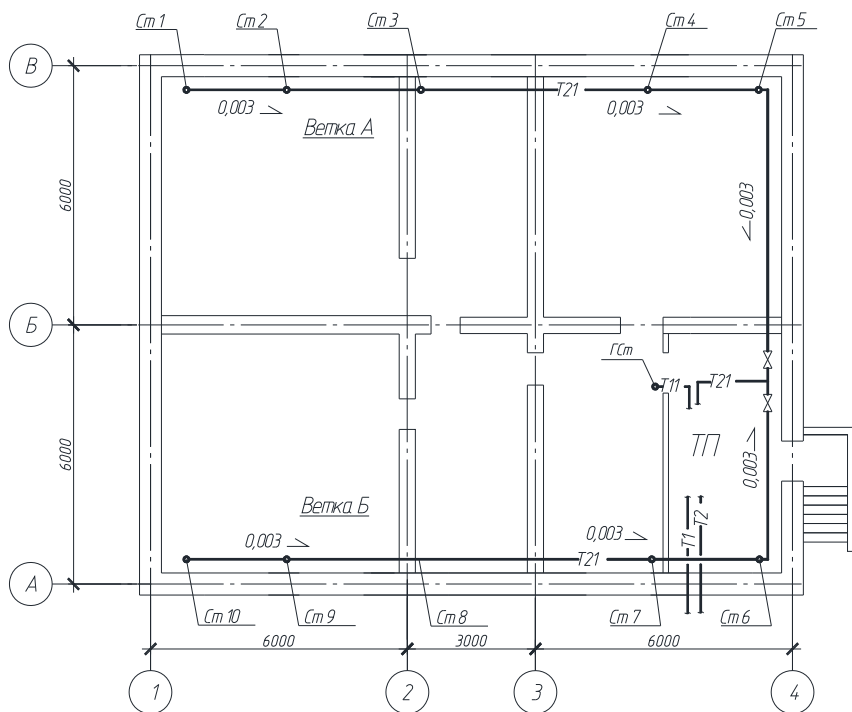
План подвала с верхней разводкой трубопроводов
